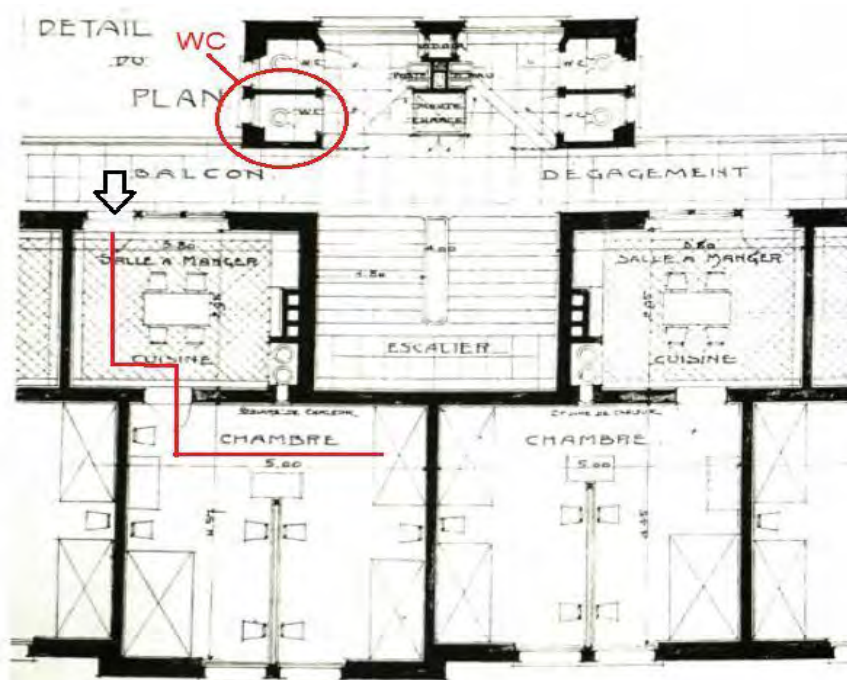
Disposition des pièces en enfilade, plan d'immeuble, Paris, 1911.
